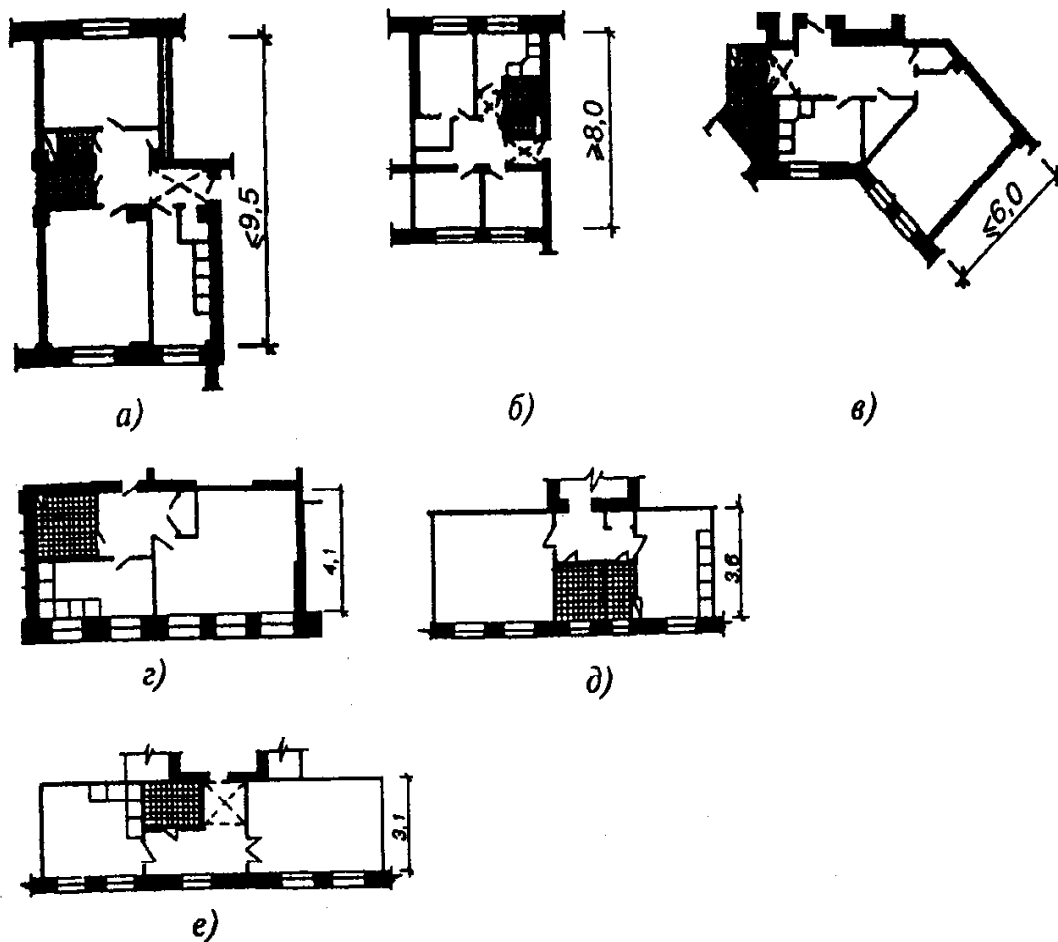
Приклади планування квартир у вузьких корпусах із невеликим поперечним архітектурно-конструктивним кроком
